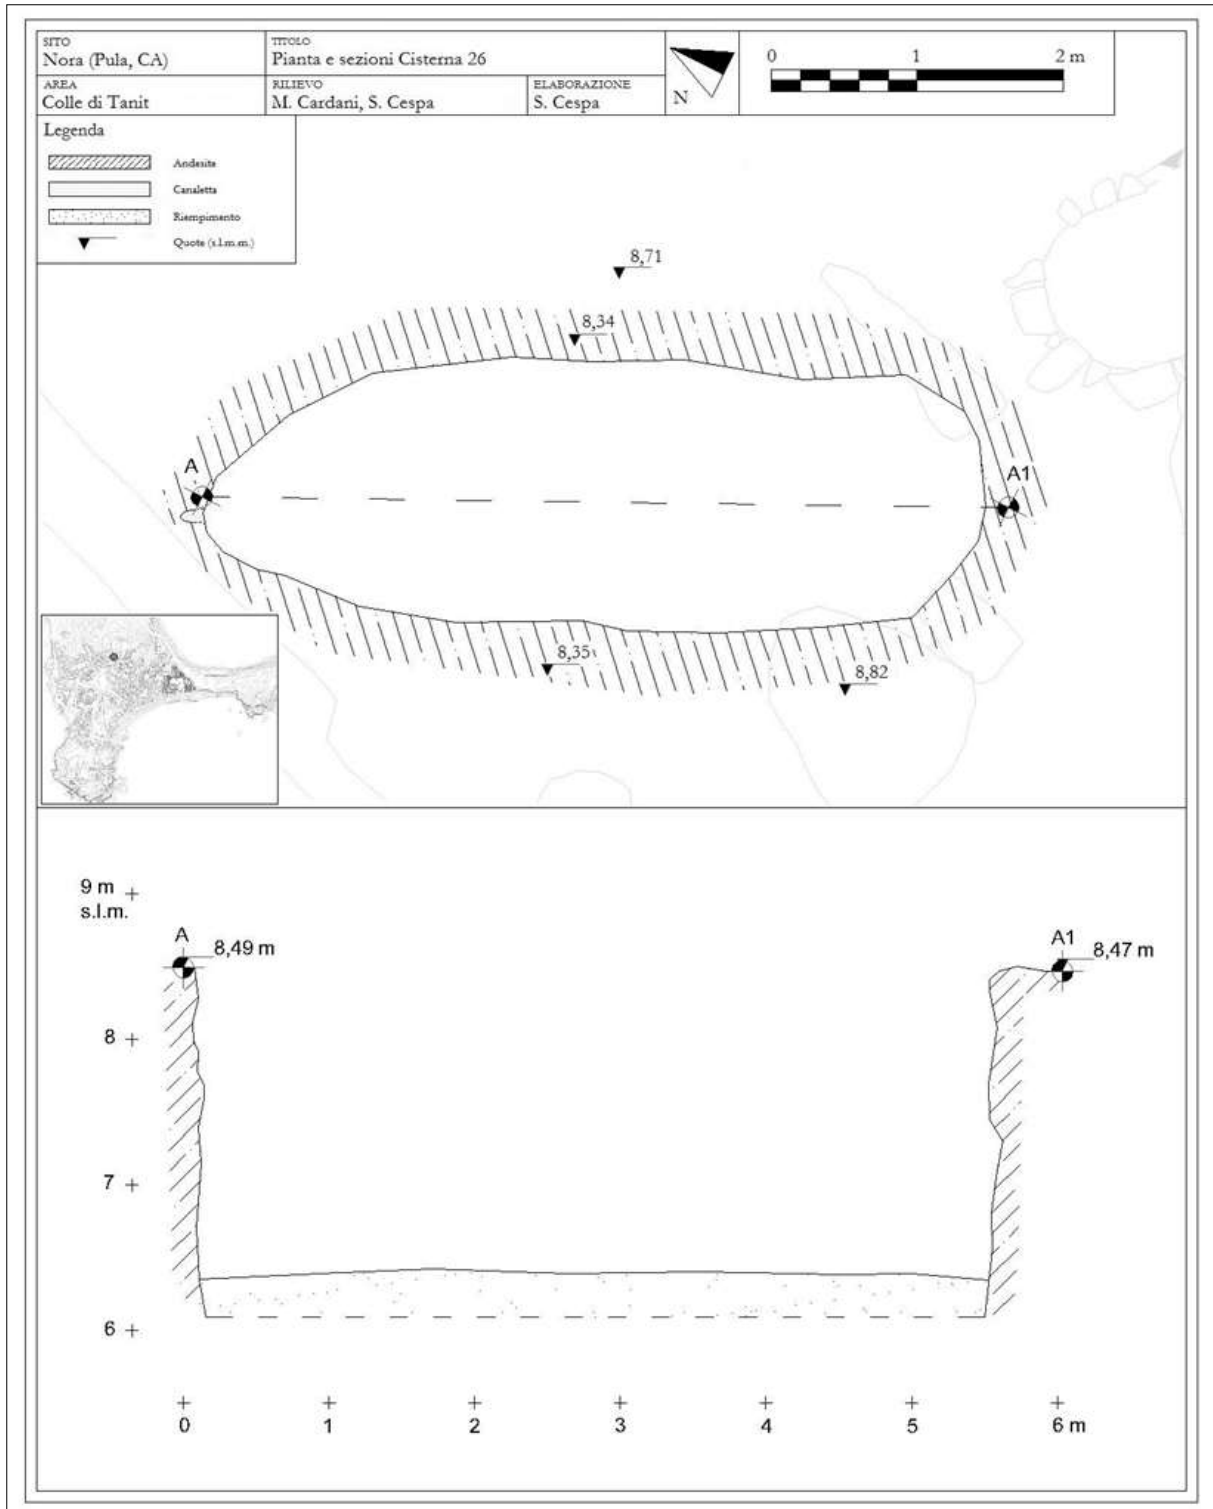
Pianta e sezioni della cisterna 26 (elaborazione dell'autore).
